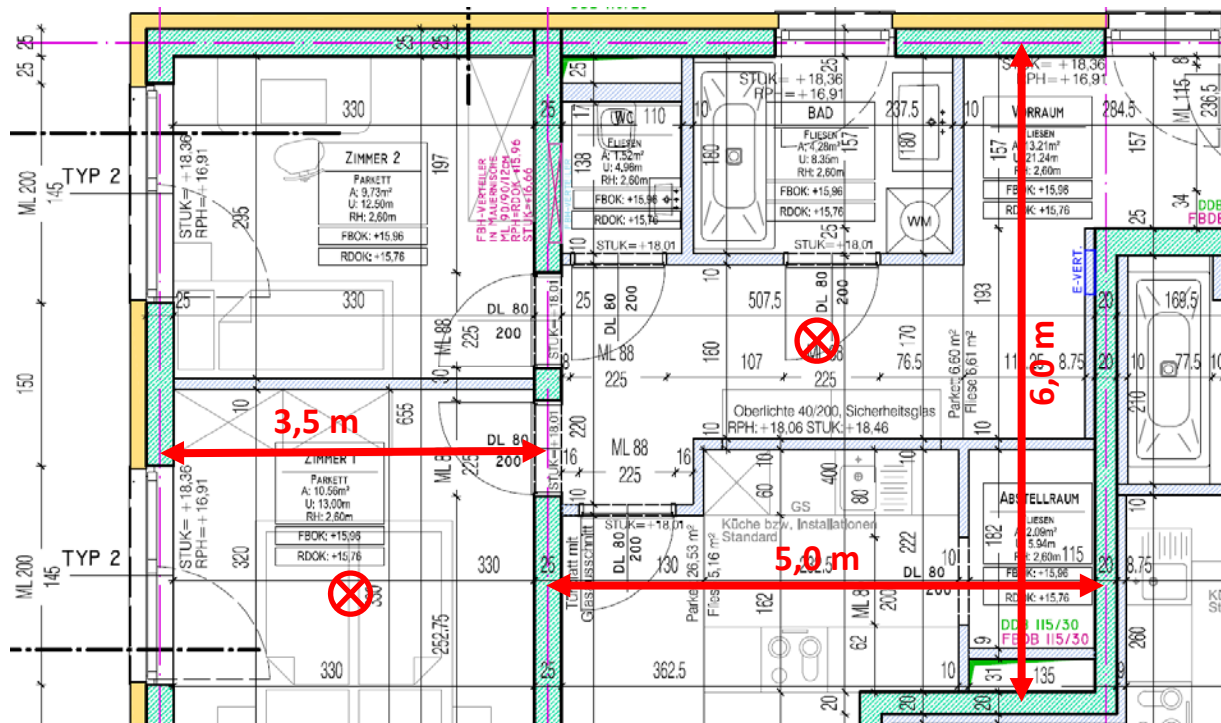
Grundriss der Regelgeschoßdecke (Plan aus[27])
